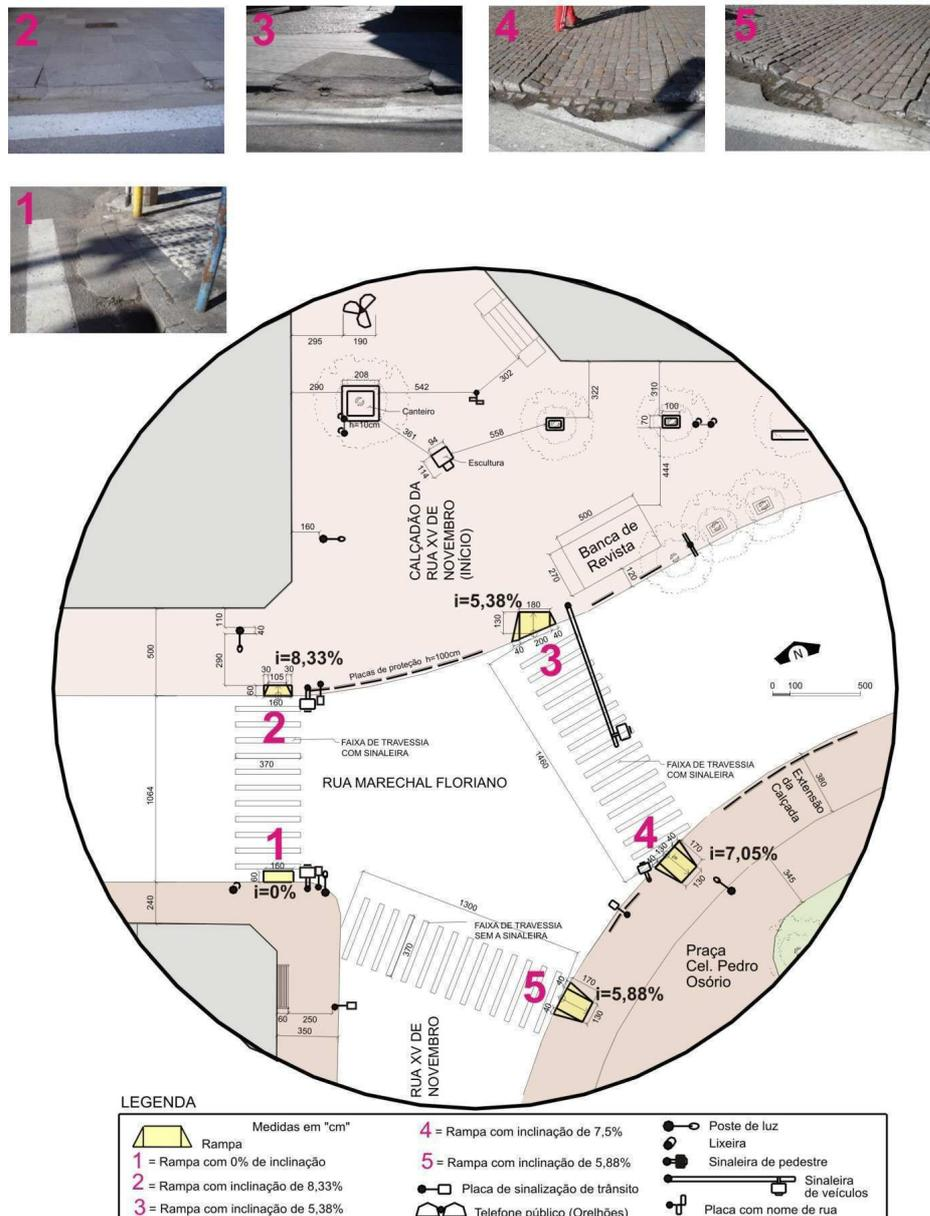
Detalhe 4 do levantamento preliminar da Figura 3.9
